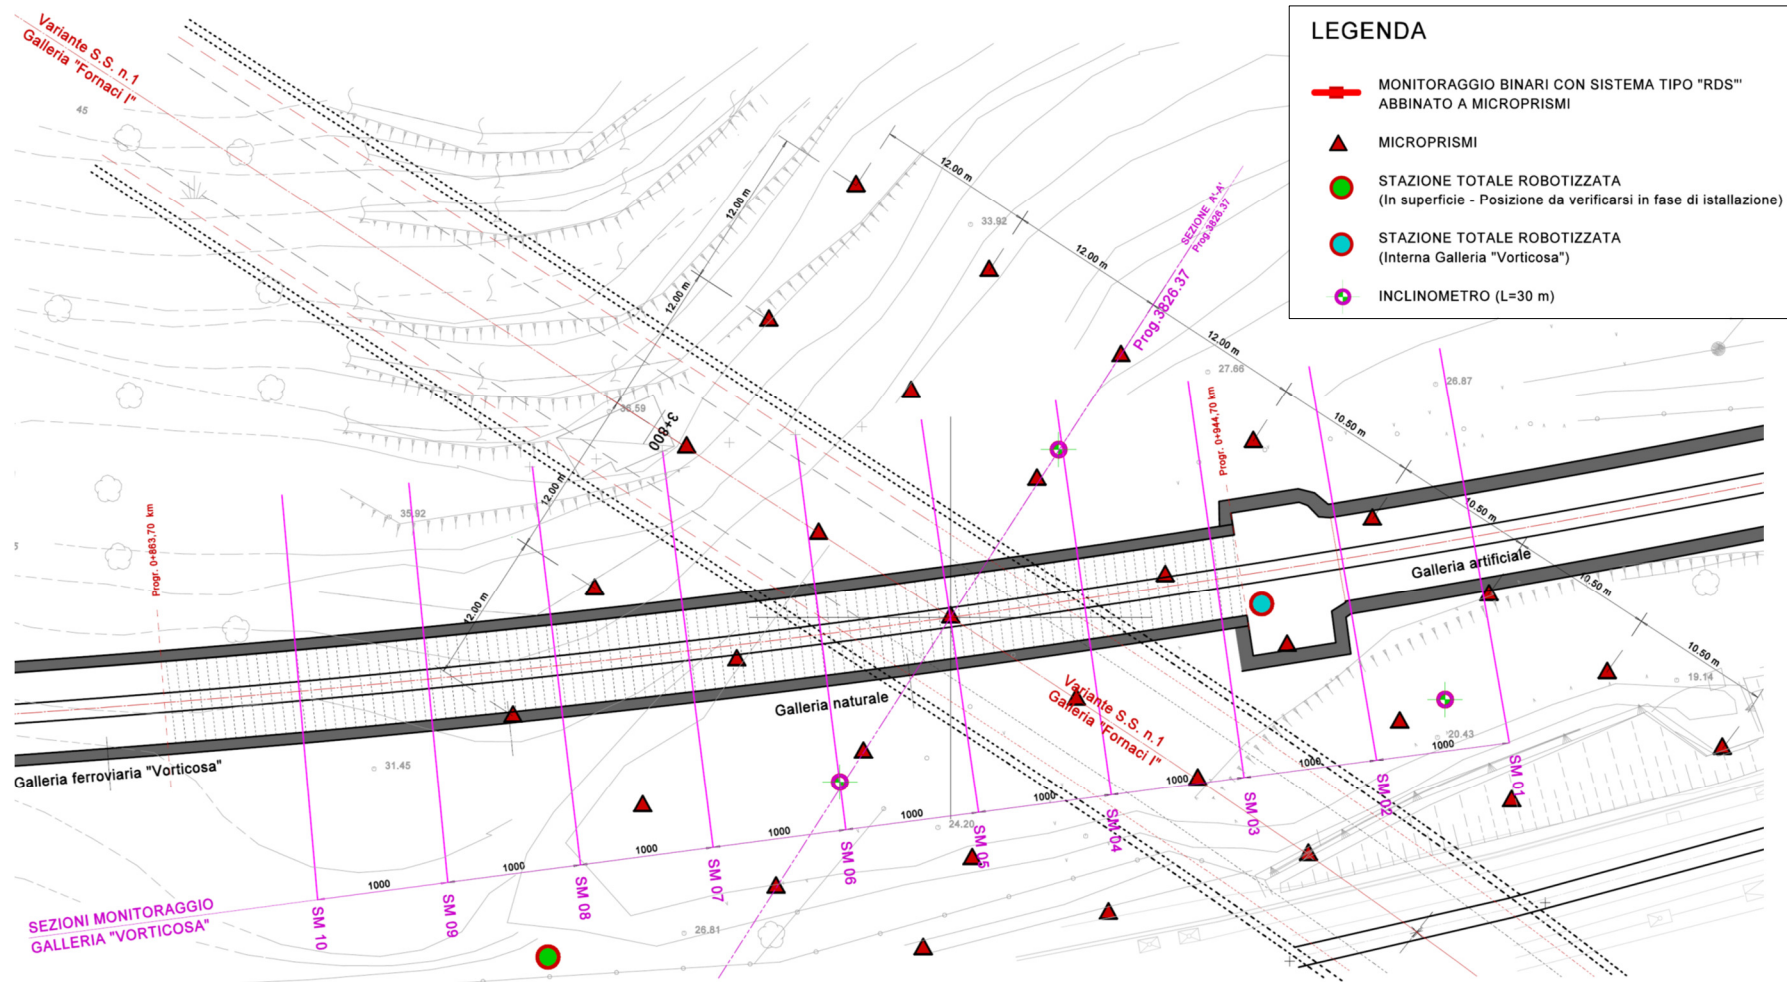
Sistemi di monitoraggio – Stralcio planimetrico
